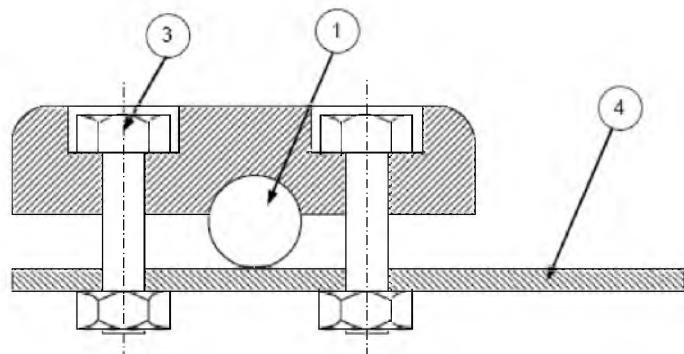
б – Сплошной плоский проводник, прикрепляемый к арматурному стержню
